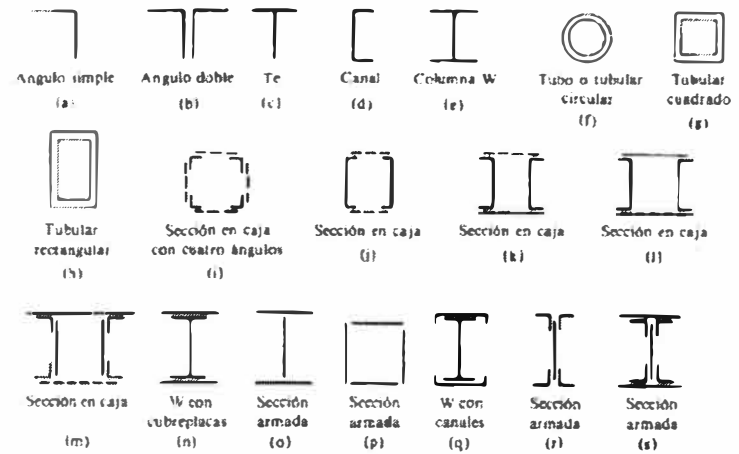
Secciones transversales típicas de columnas de acero (McCormac, 1996, p.99).
